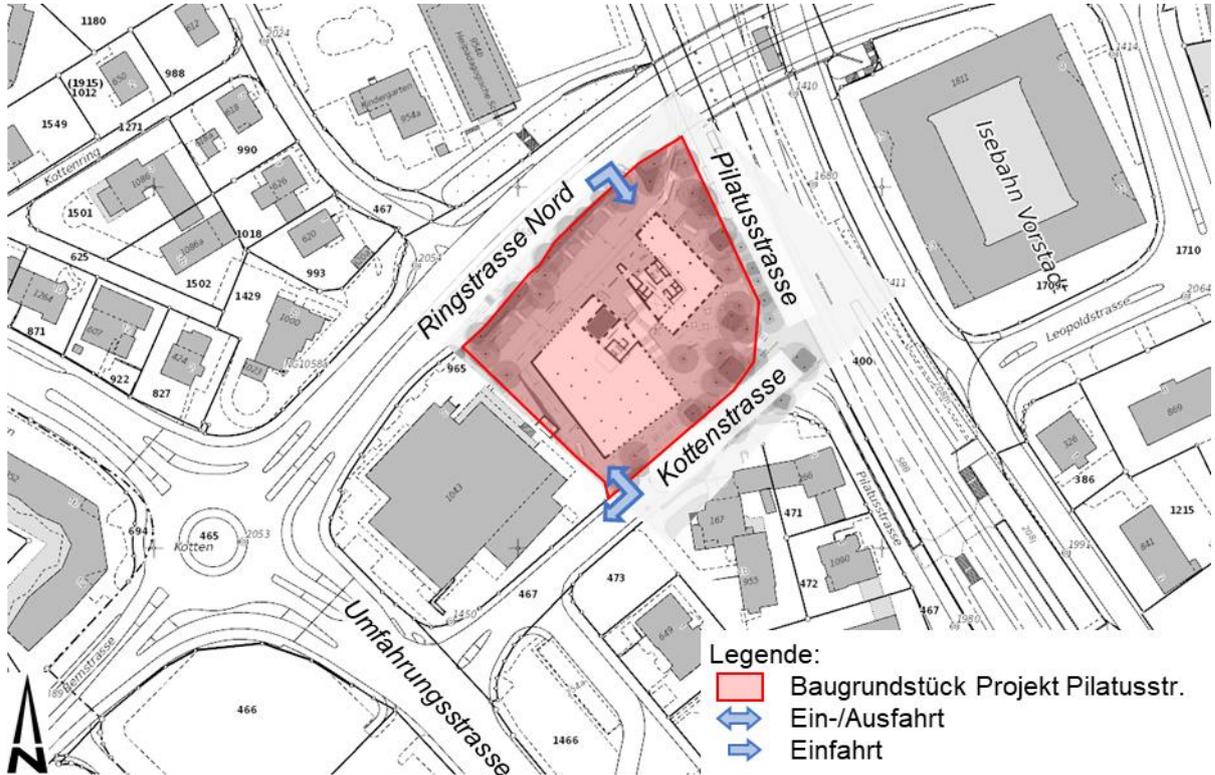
Situation und Erschliessung Projekt Pilatusstrasse (Plangrundlagen [2],[1], [7])
